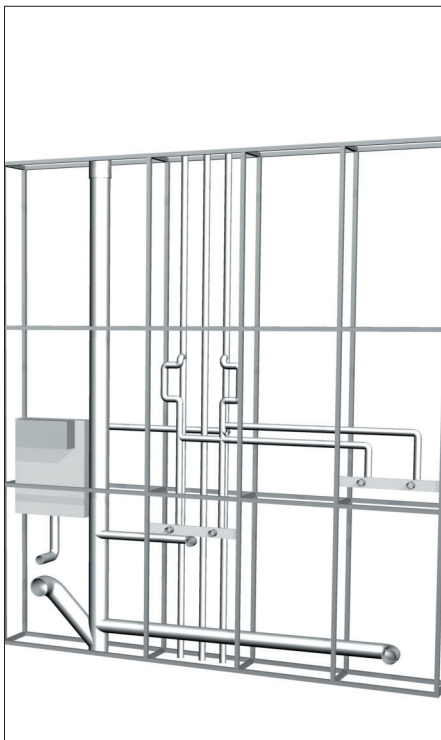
Das offene Vorwandelement ist ein Zusammenschluss mehrerer offener Installationsblöcke zu einem Bauteil. Die Konstruktion besteht aus selbsttragenden Rahmenprofilen. Als Material können dabei Metallprofile oder Holzständerkonstruktionen gewählt werden. Das Profil ist so hoch wie das höchste Sanitärelement. In diesem Gestell werden Wasser- und Abwasserleitungen sowie nach Bedarf Lüftungsrohre geführt. Alle Sanitärkomponenten wie Spülkästen und entsprechende Befestigungen für die Sanitärgegenstände sind in der Vorwand bereits enthalten. Auf der Baustelle muss die Konstruktion verfüllt und verkleidet werden. Der Austausch einzelner Leitungen und die Einbringung von zusätzlichen Anschlüssen und Leitungen kann erfolgen. Dies ist im eingebauten und verkleideten Zustand jedoch nicht zerstörungsfrei möglich. Eine Veränderung der Position der Sanitärgegenstände ist auf der Baustelle nicht mehr möglich. Das System eignet sich für Renovierung, Neubau und Komplettisanierung.
